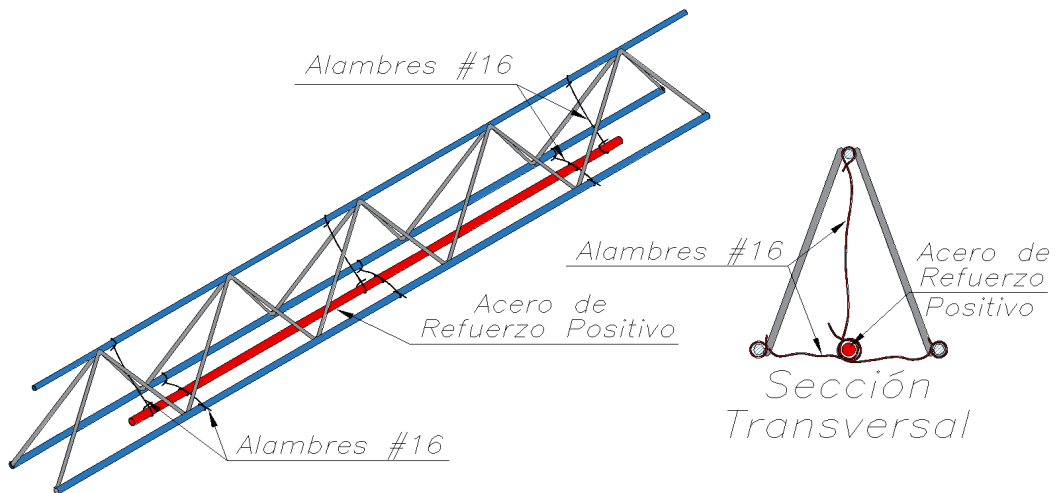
Colocación y Fijación del Acero de Refuerzo Positivo, en el Tralicho.
